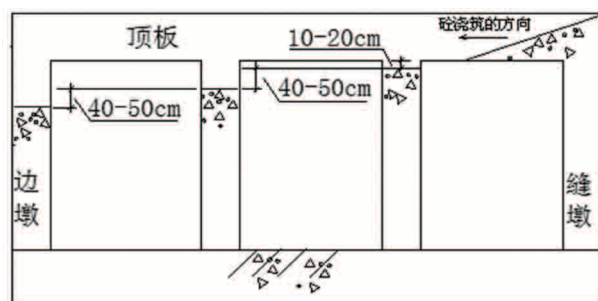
流道墩墙混凝土浇筑面高程台阶状布置图
